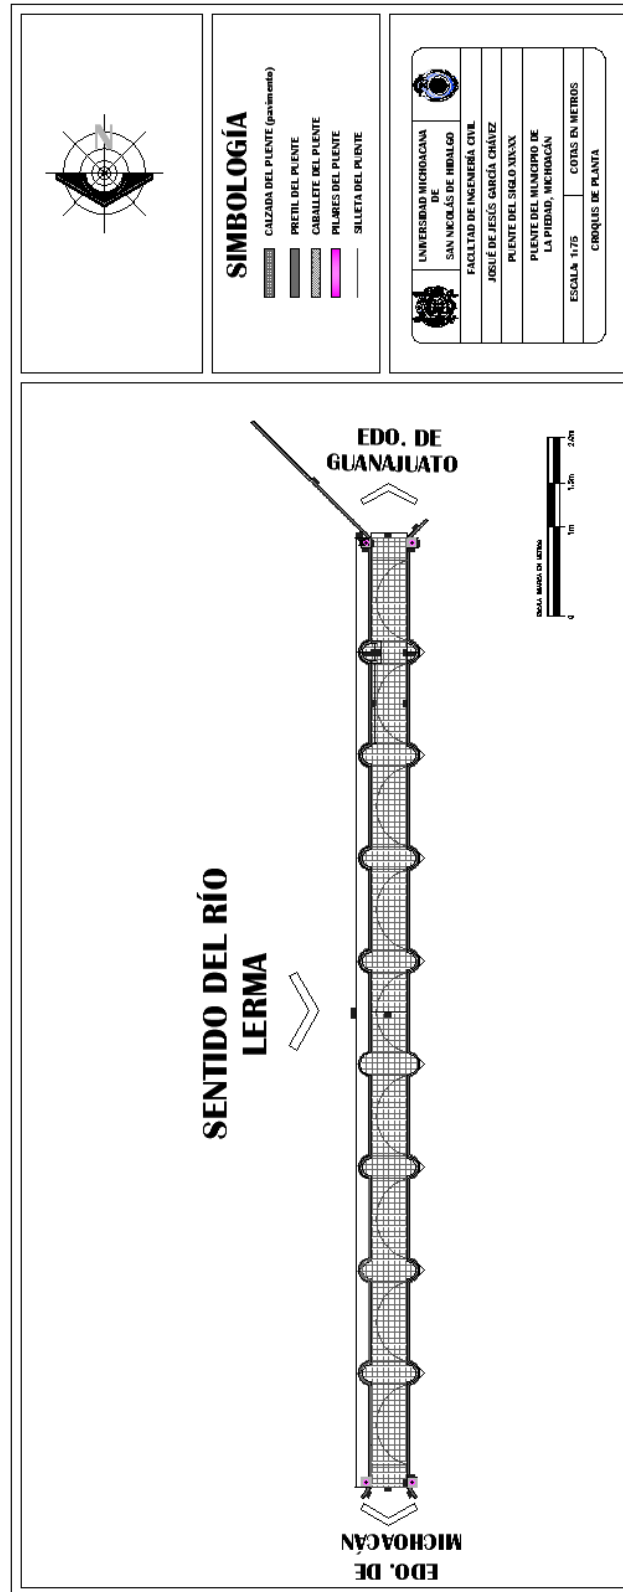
Croquis en planta del puente ubicado en el Municipio de La Piedad, Michoacán.
